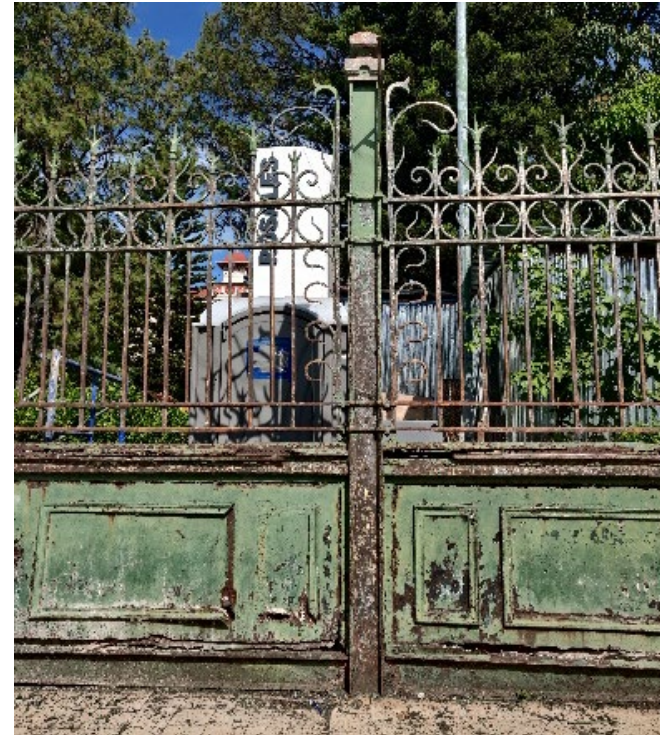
Columna Tipo 1 del Barandal Hospital Rosales
